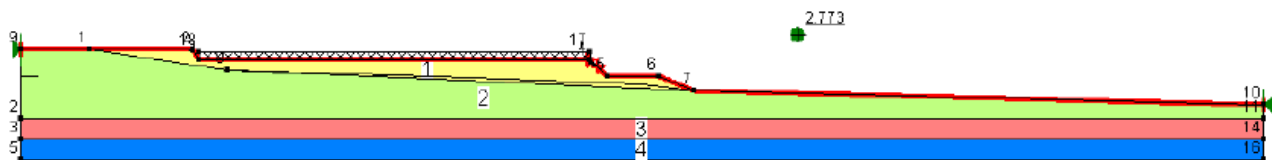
Detalhe da seção transversal de estudo, para o caso 3, com execução de aterro subjacente ao piso do Terminal Pesqueiro.
